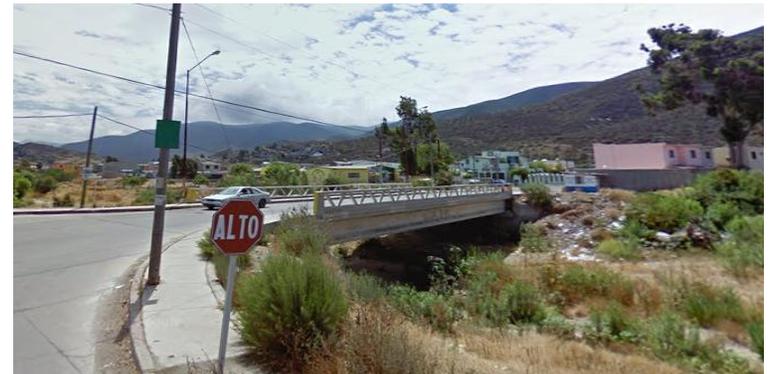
vista del puente Villa Bonita, a un costado del arroyo
